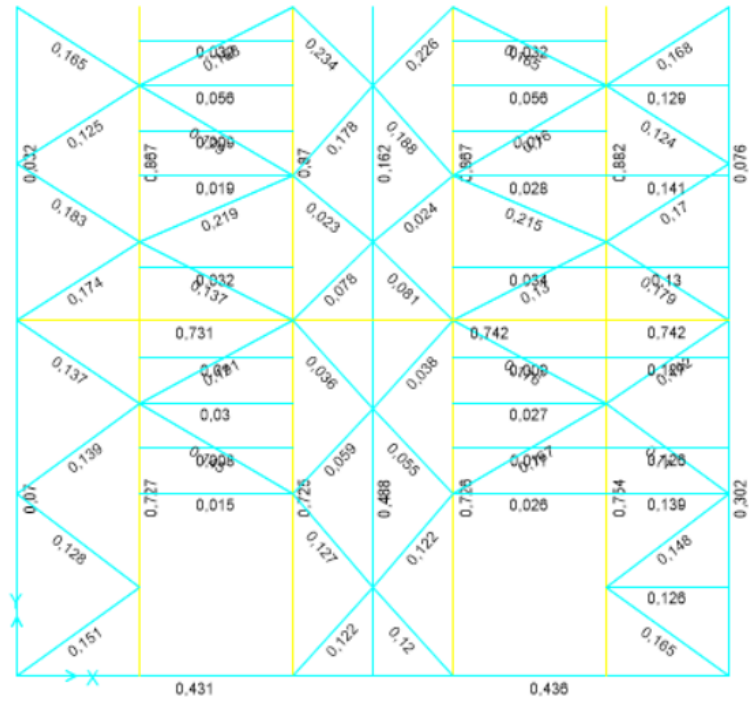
Factores de utilización vista en planta elevación 12 m.
